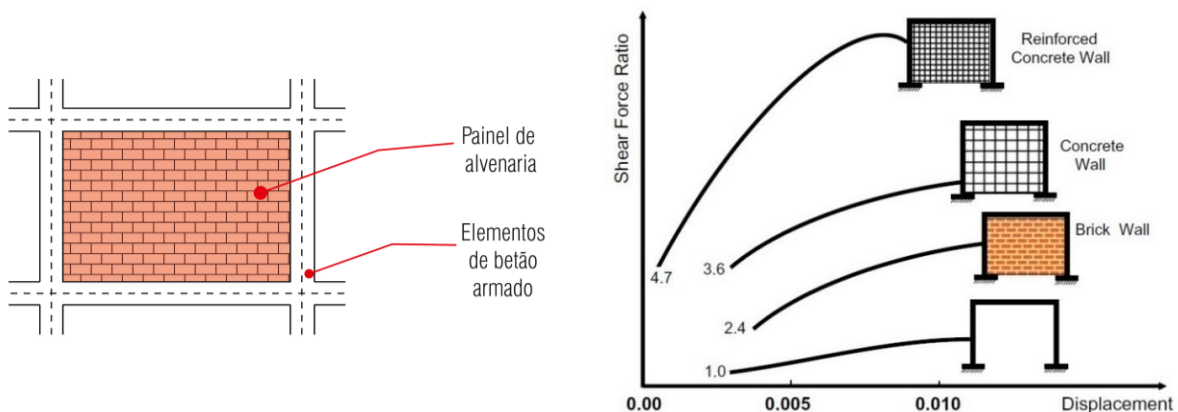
(a) Pórtico de betão armado com enchimento de alvenaria de tijolo [adap. (Guerreiro, 2014)]; (b) Efeitos de paredes no deslocamento lateral de estruturas (Kirac et al., 2011).
